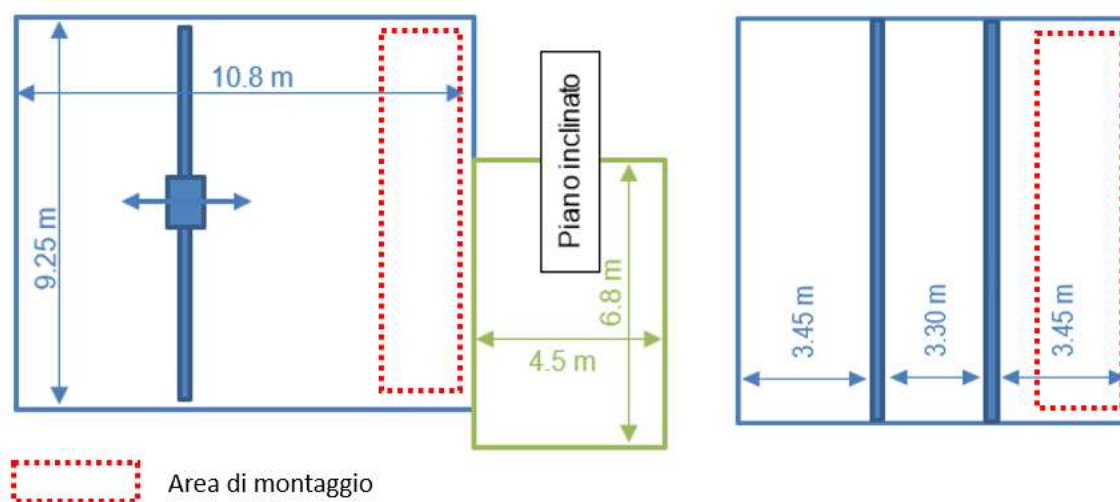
Piante della camera valvole, con direzione di movimento del carroponete (a sinistra), posizione dell'area di montaggio e delle travi nella soletta di copertura (a destra)
